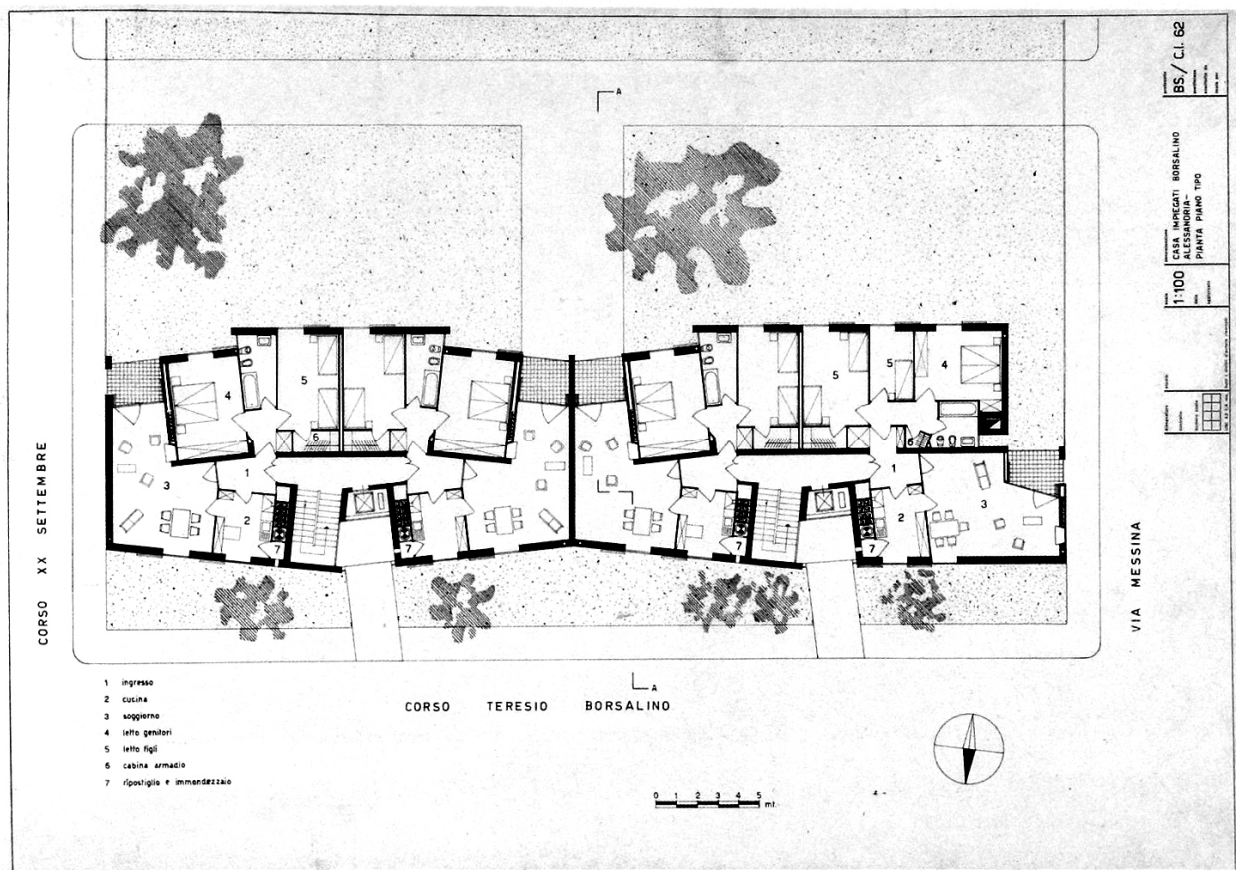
Planimetria del piano tipo. *Typical floor plan
